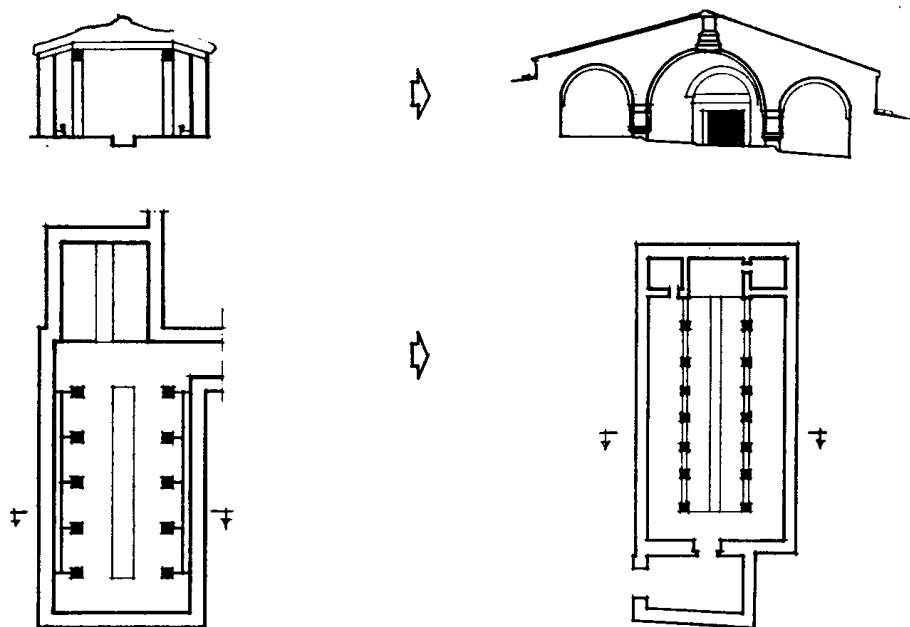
Le caravansérail à trois nefs et son prototype traditionnel: à gauche: coupe et plan du *gom*; à droite: coupe et plan du caravansérail de Selim.
